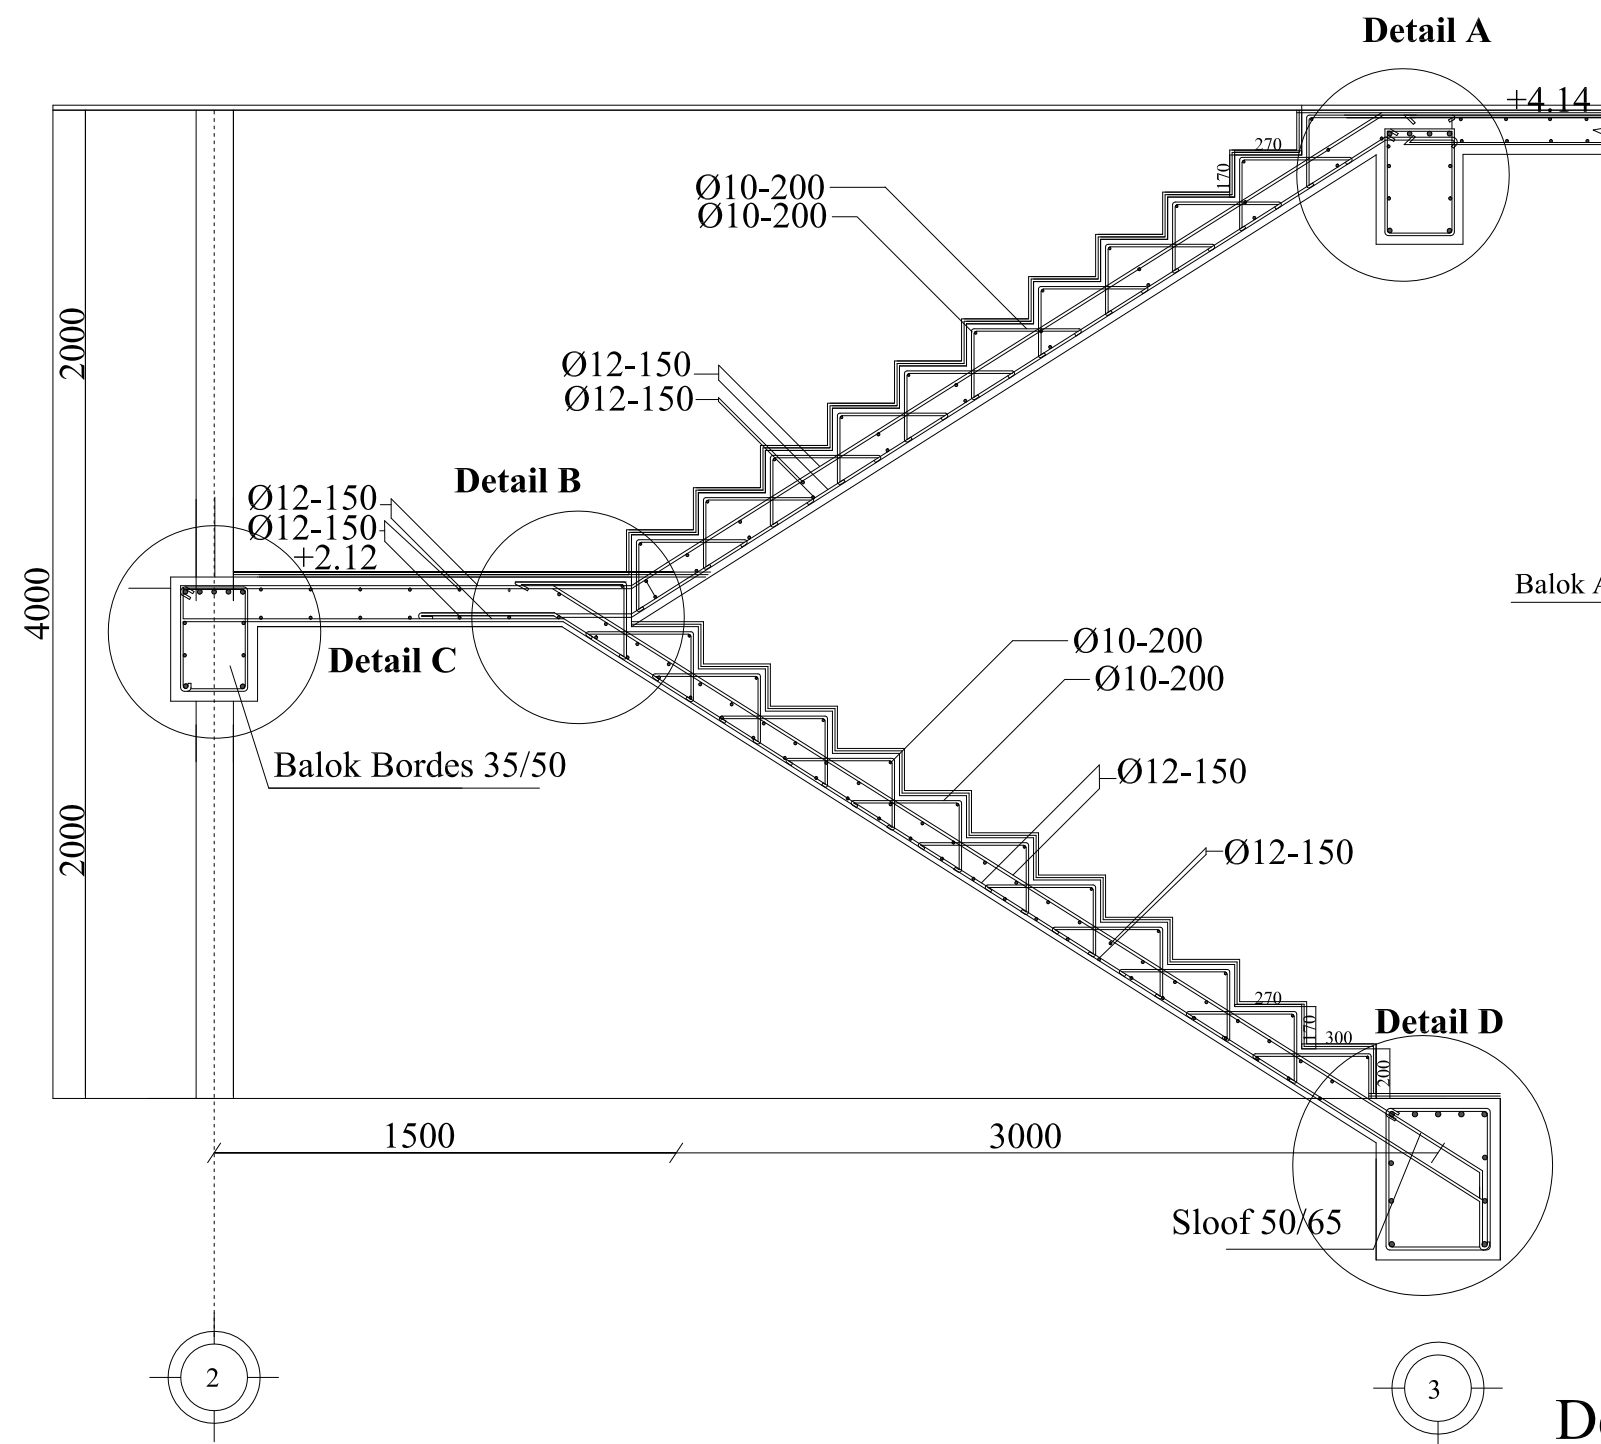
DETAIL TULANGAN TANGGA TIPE 1 AS (2°-3)
